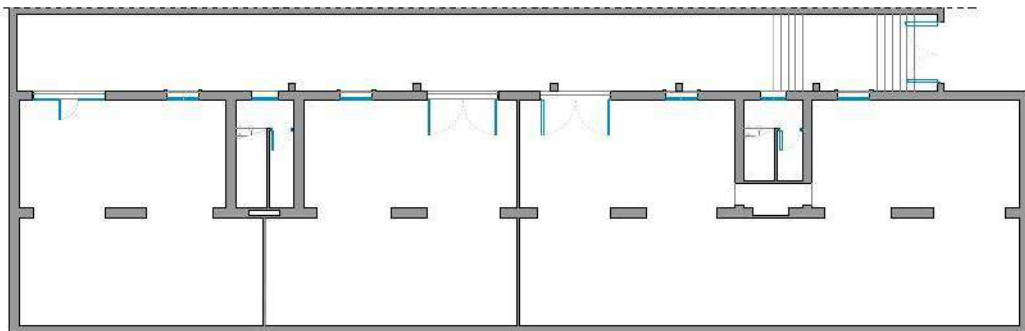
Distribución planta sótano. 2016. Fuente Propia
